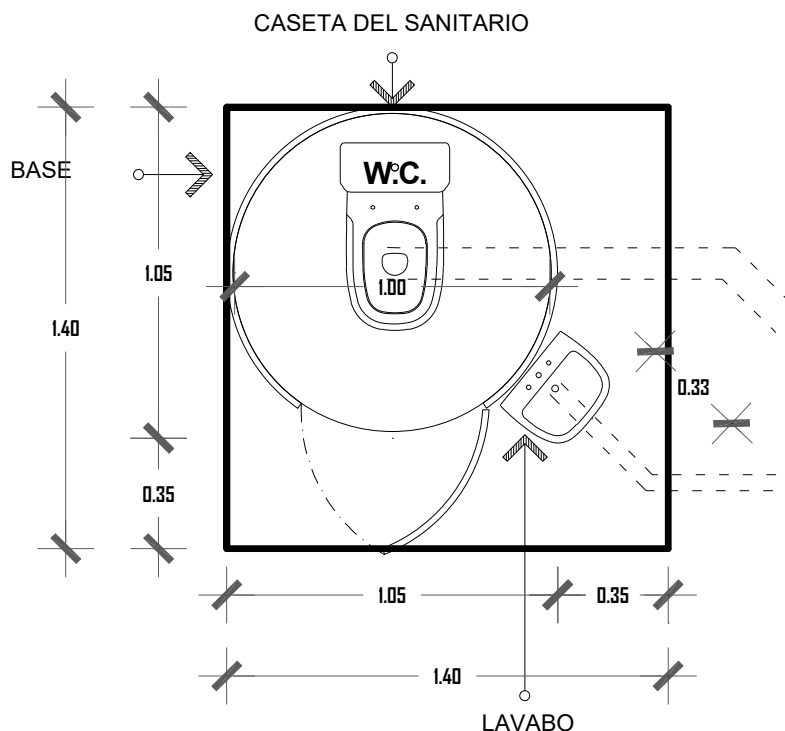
Dimensión de la plancha de concreto y caseta del biodigestor levantado en campo.
